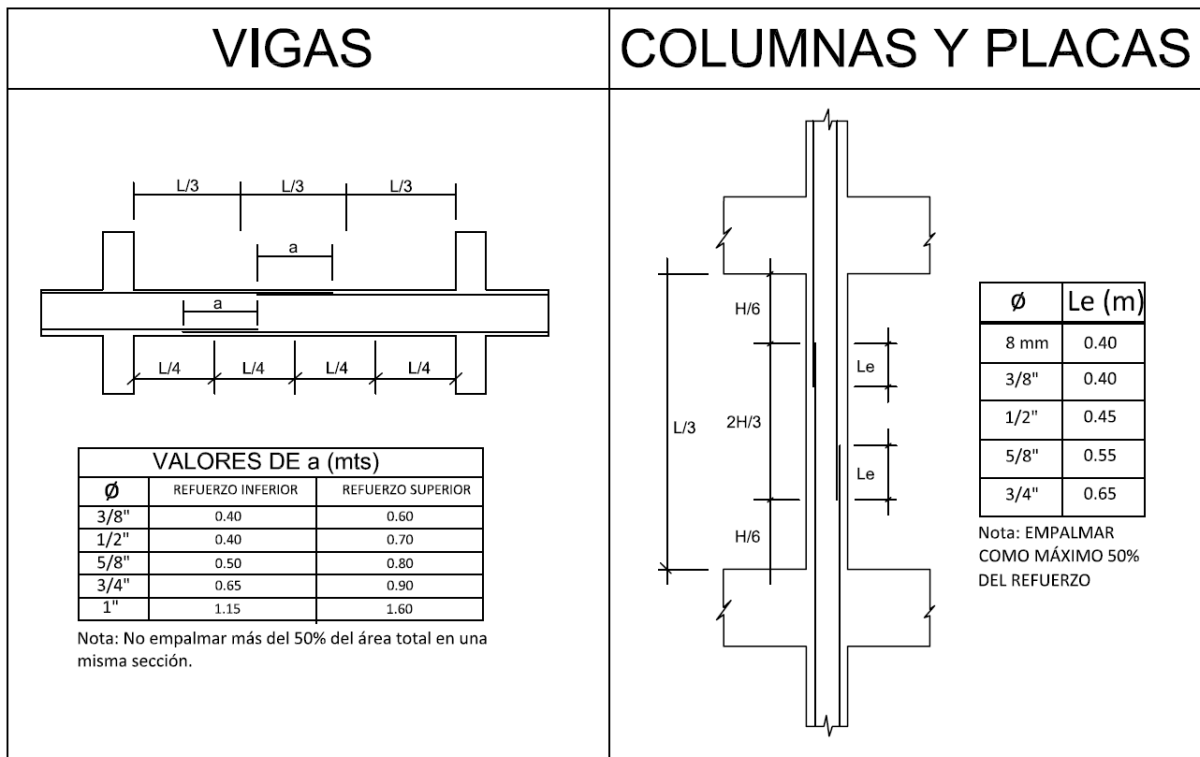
Configuración de empalme en vigas, columnas y placas.
